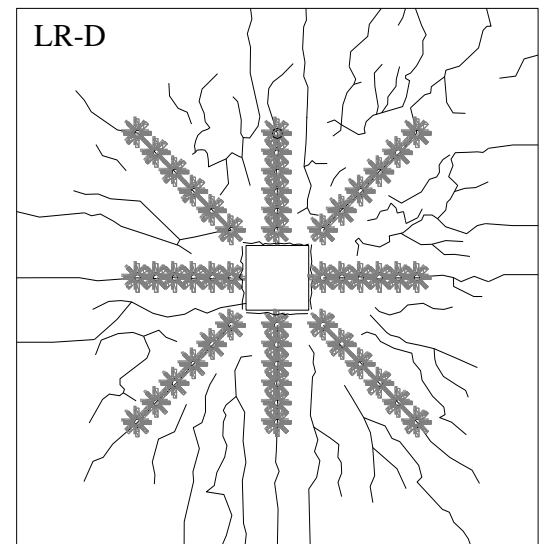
Padrão de Fissuração - LR-D
